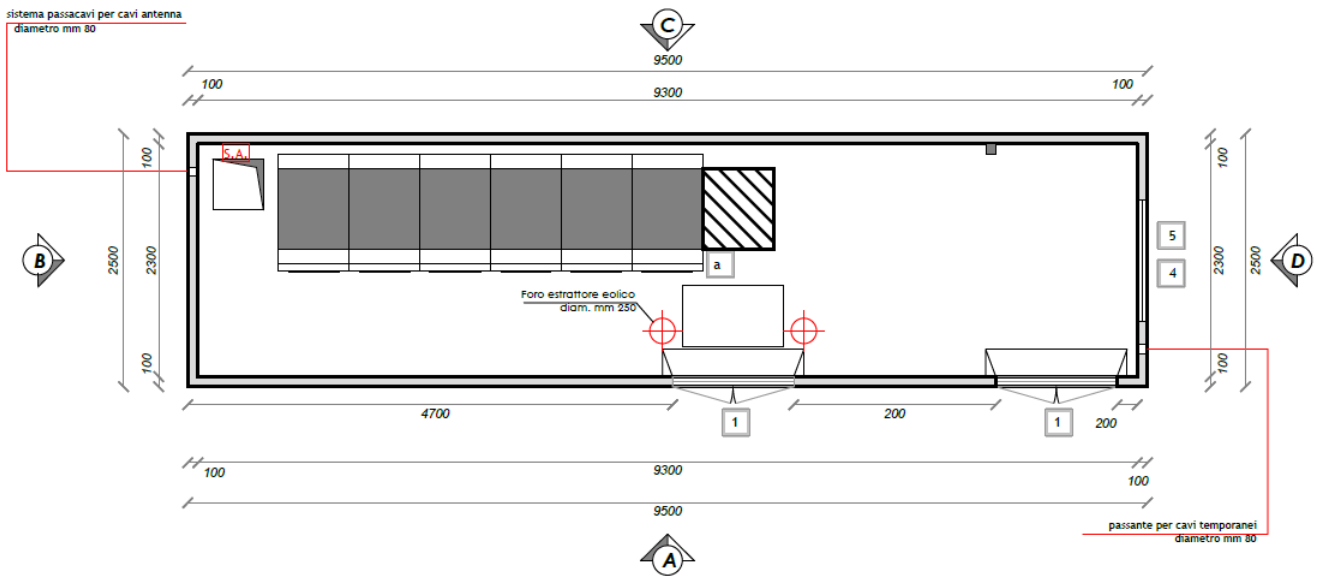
Planimetria cabina di raccolta – vista dall’alto
